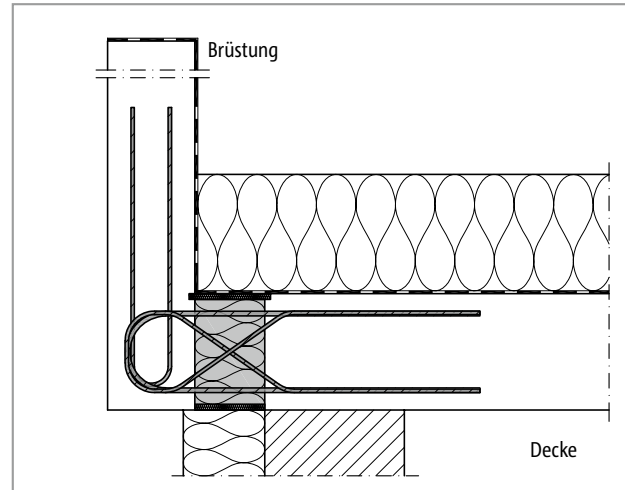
Schöck Isokorb® XT Typ F mit Brandschutz
